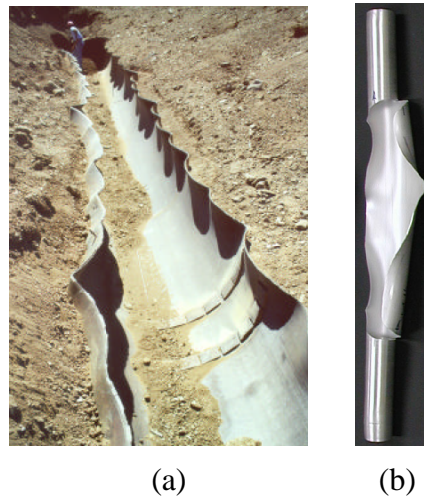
Déchirure du tube par explosion, (a) [1] et (b) [173]
